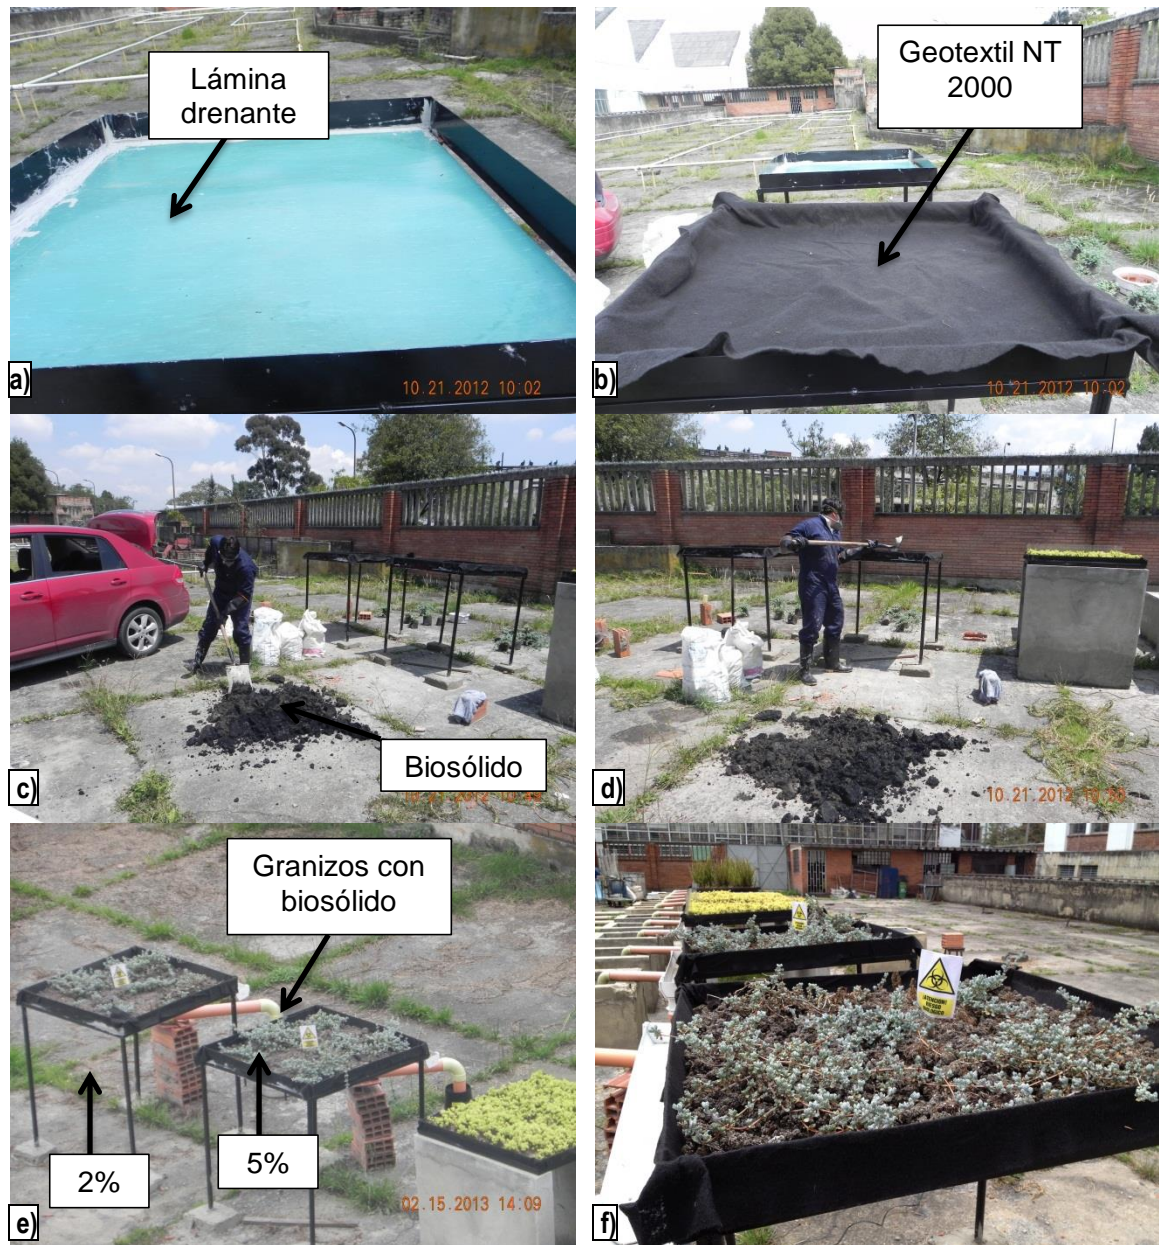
Instalación de cubiertas verdes con BIOSÓLIDO.
